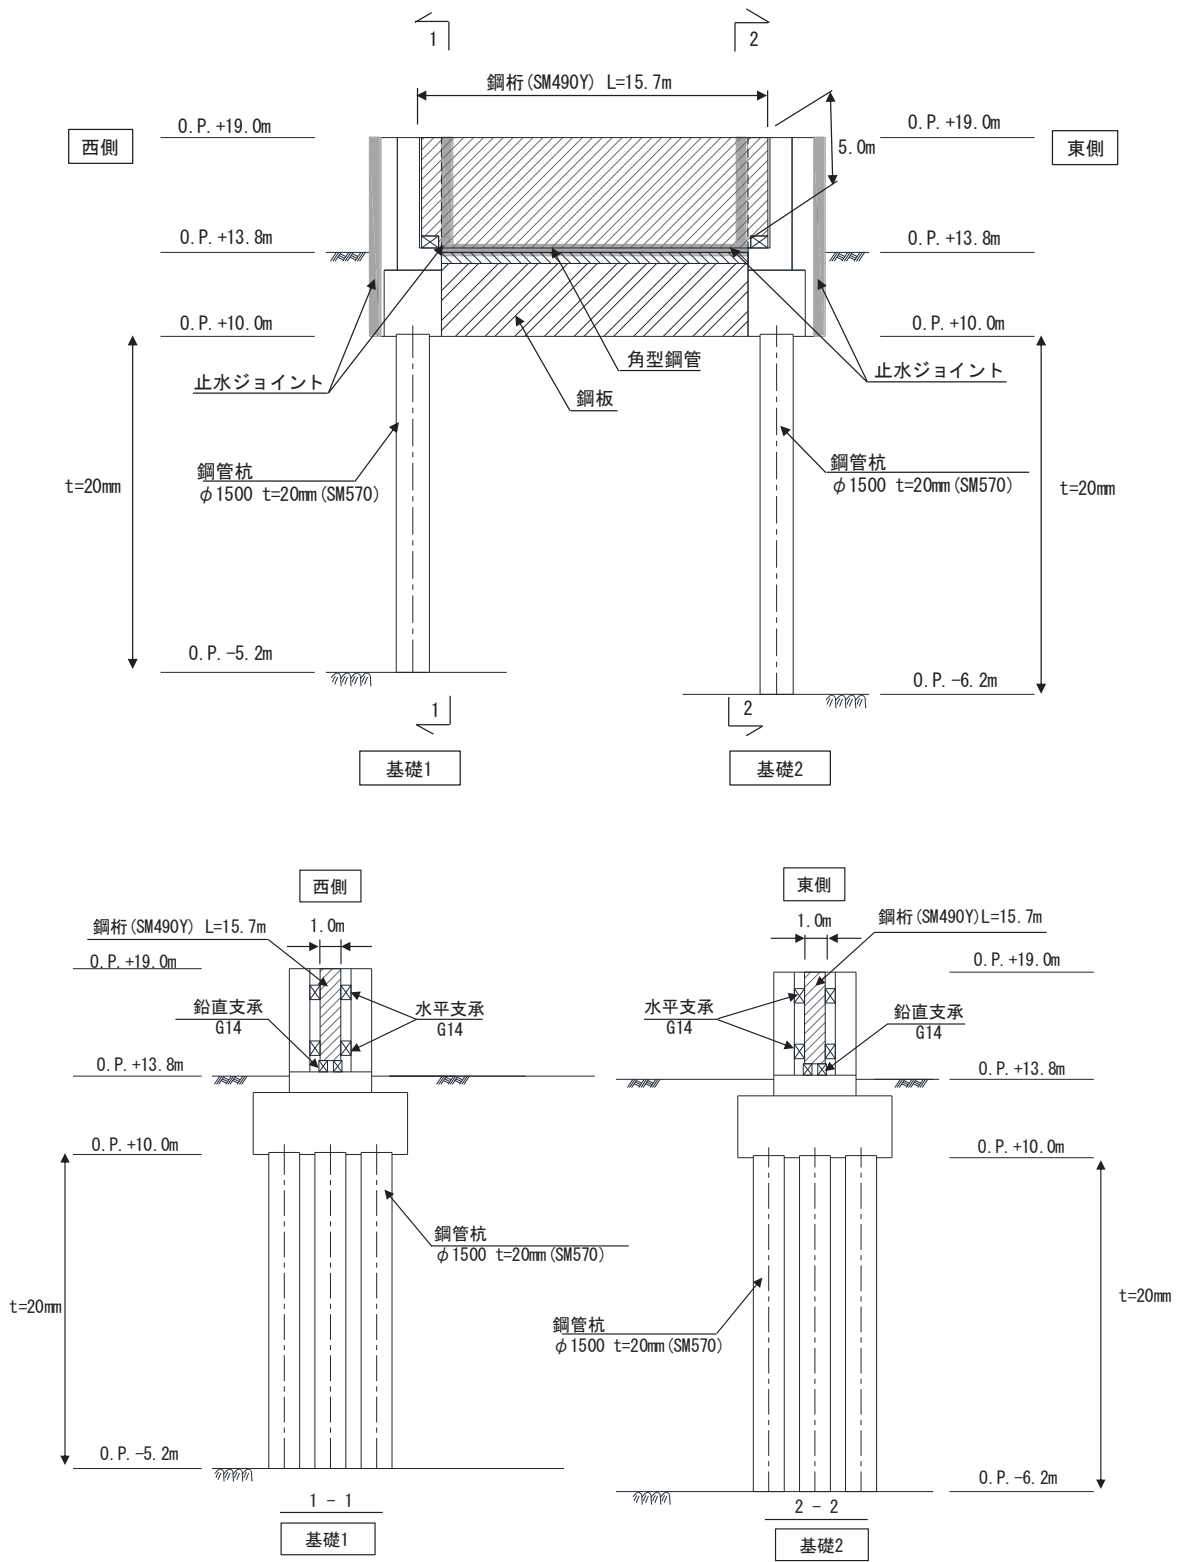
鋼製遮水壁 (鋼桁 3) 正面図及び断面図
